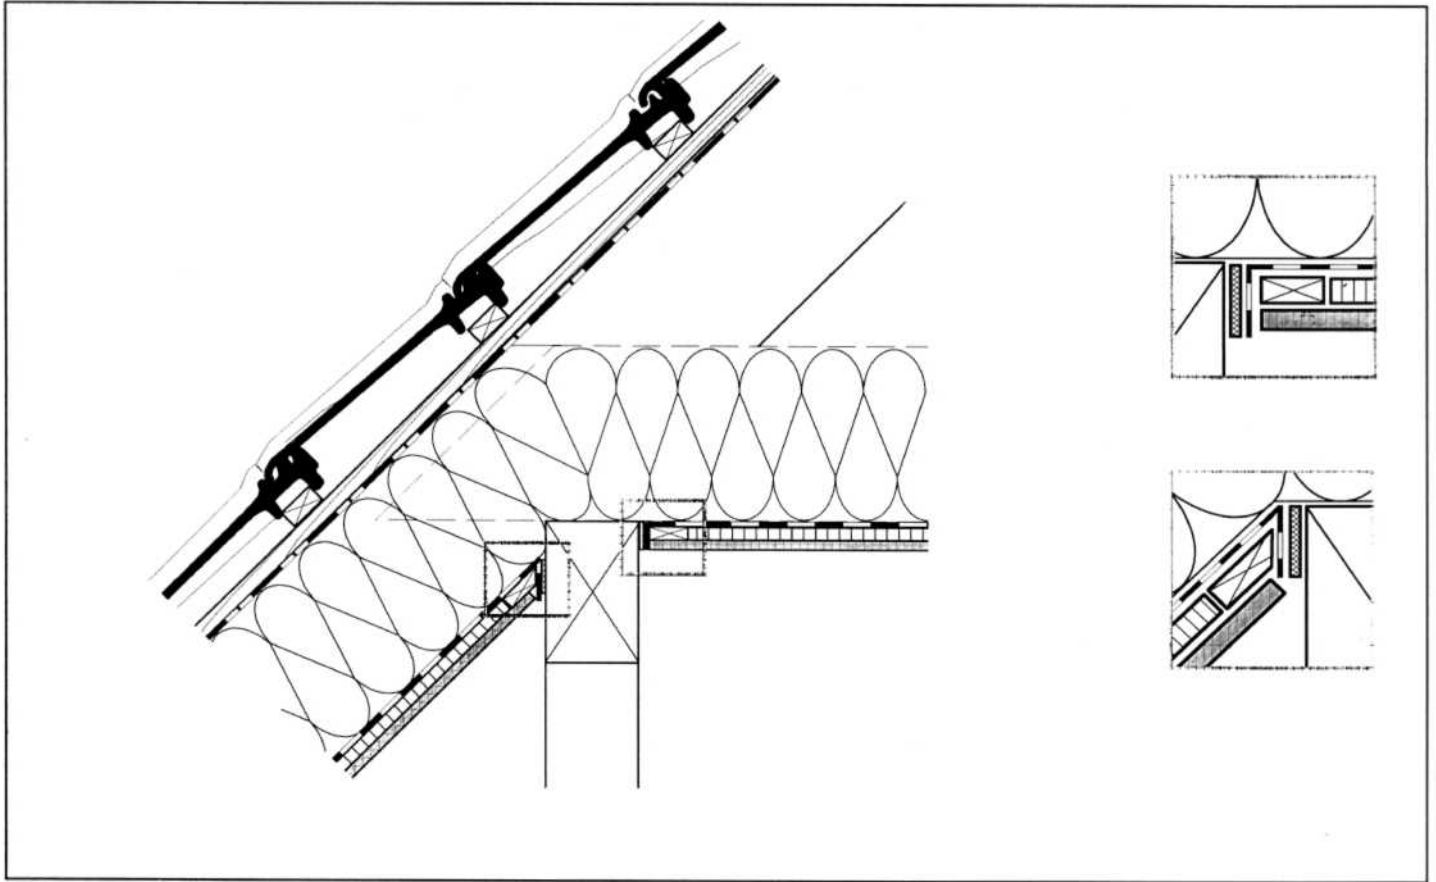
Detailausbildung im Bereich der Mittelfette für die Dachkonstruktion D 1.
